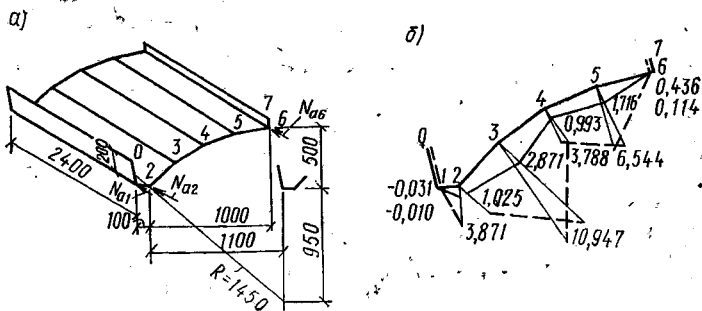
Железобетонная складка, усиленная продольной предварительно-напряженной арматурой
